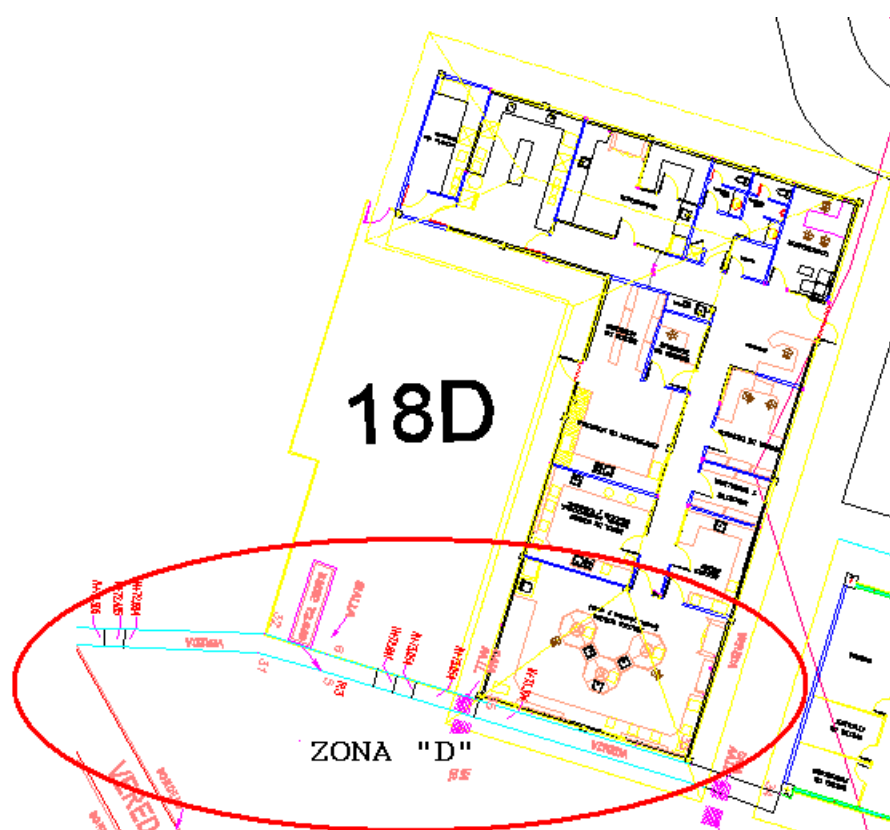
VISTA EN PLANTA DE LA ZONA "D"
